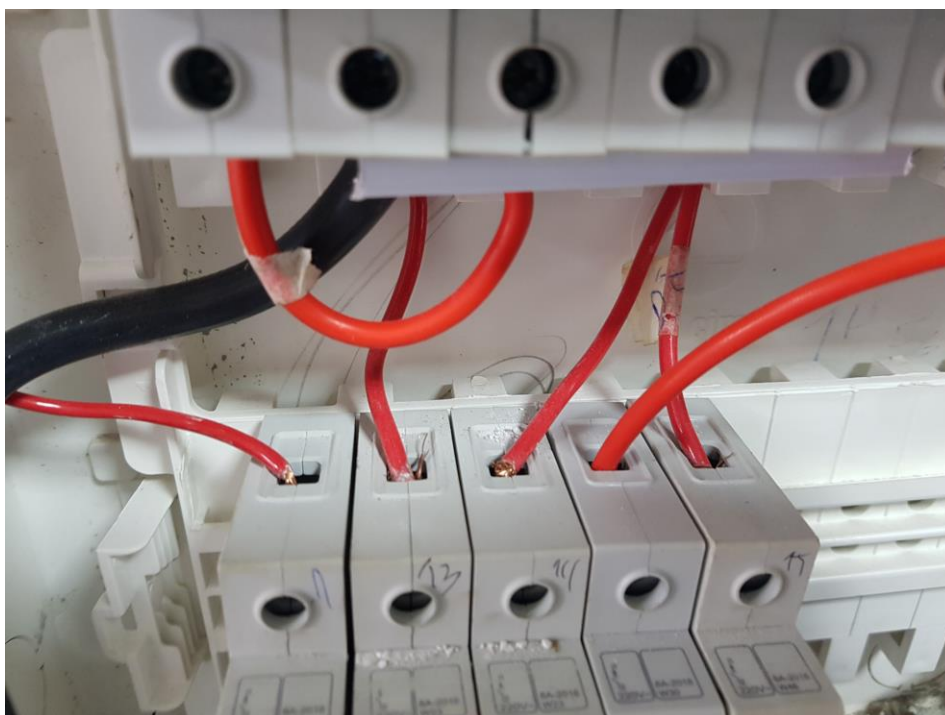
Jumpers e conexões mal feitas – Fonte Autor
